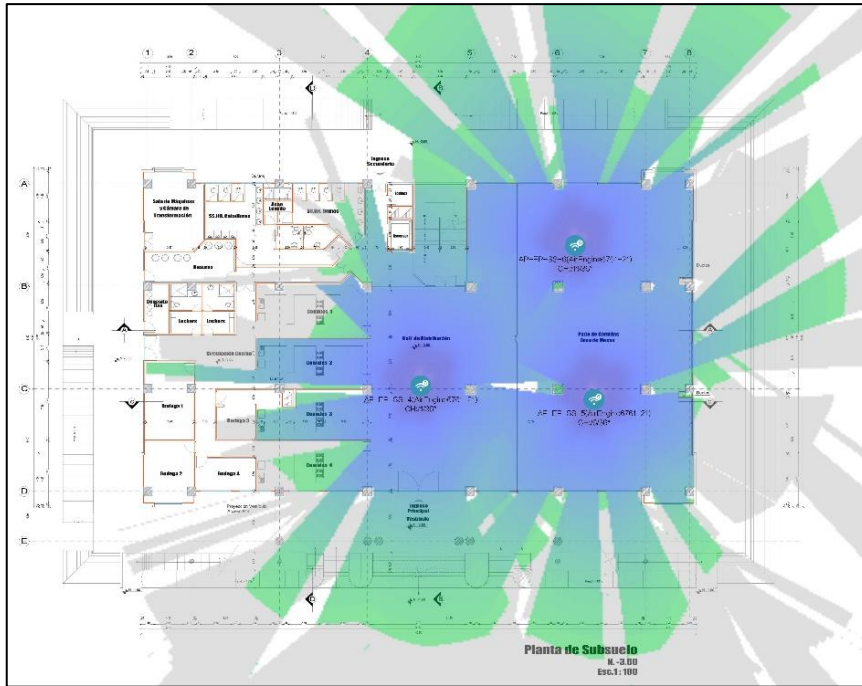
Edificio de Posgrados - Planta de Subsuelo
